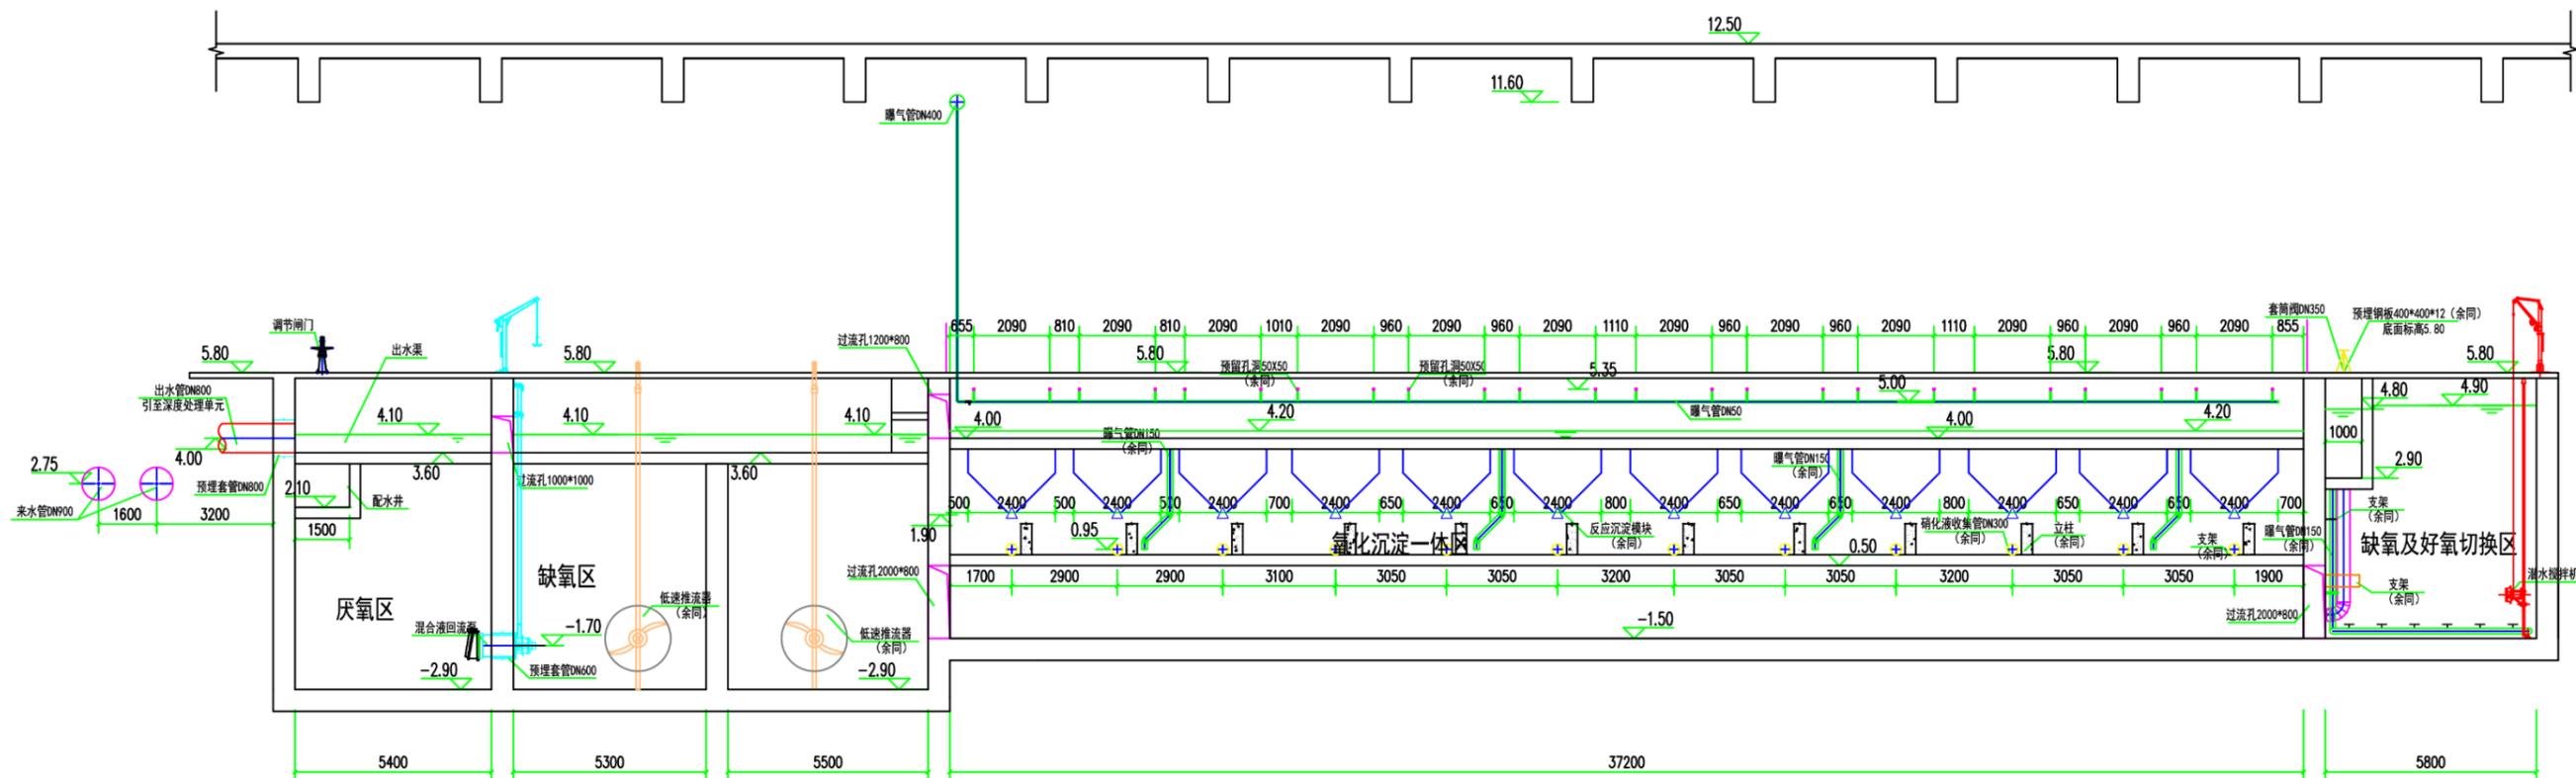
生物反应沉淀一体化池剖面图 (3-3 断面)
